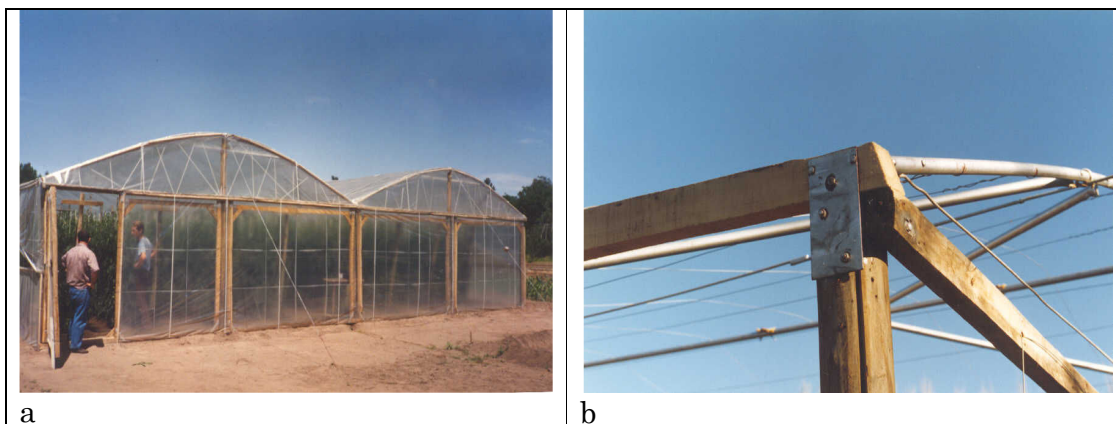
invernadero de estructura de madera. a) vista exterior b) vista interior
